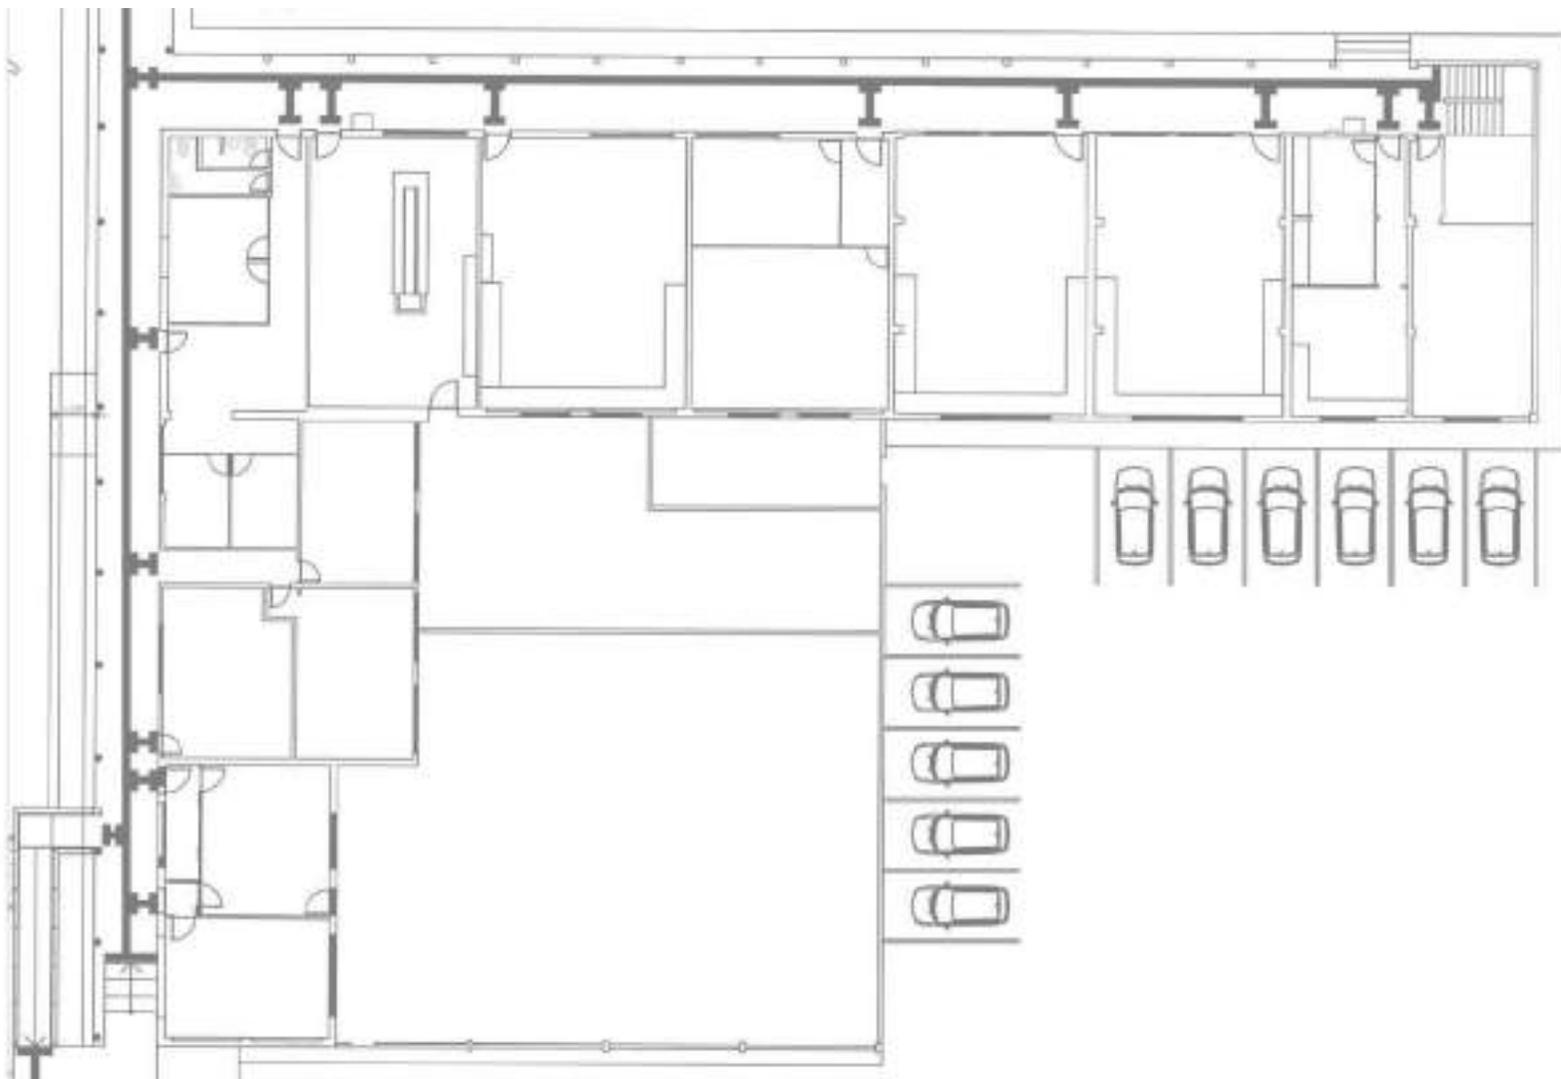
Planta baixa do pavimento térreo do IFPB, campus João Pessoa
